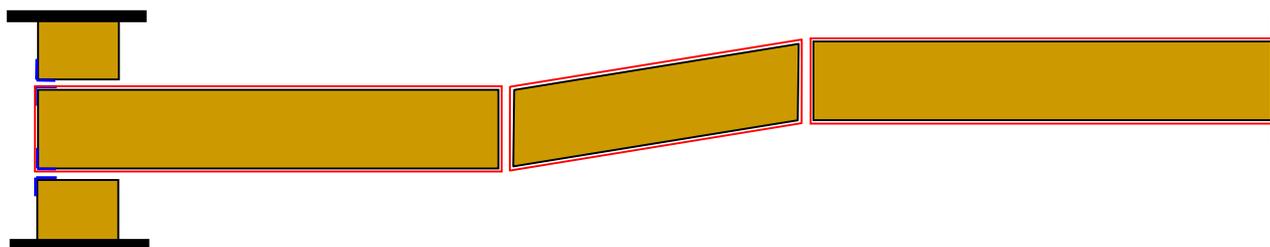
Disposizione in pianta di una catena realizzata con il sistema CAM che segue le irregolarità geometriche della parete.
